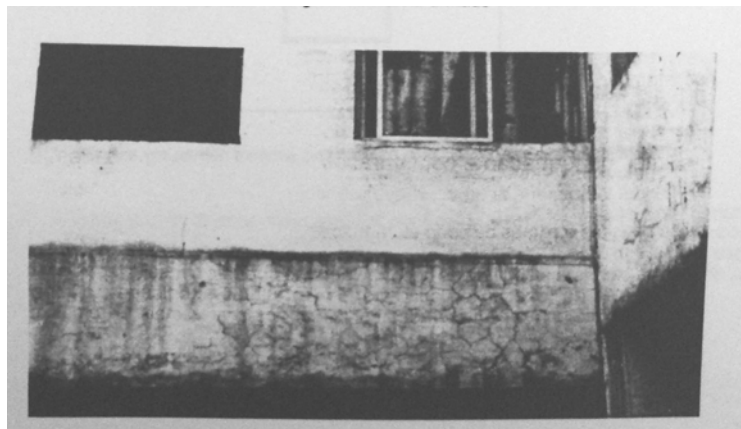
Fissuras de retração em viga de concreto armado, causadas pela elevadíssima relação água/cimento do concreto
